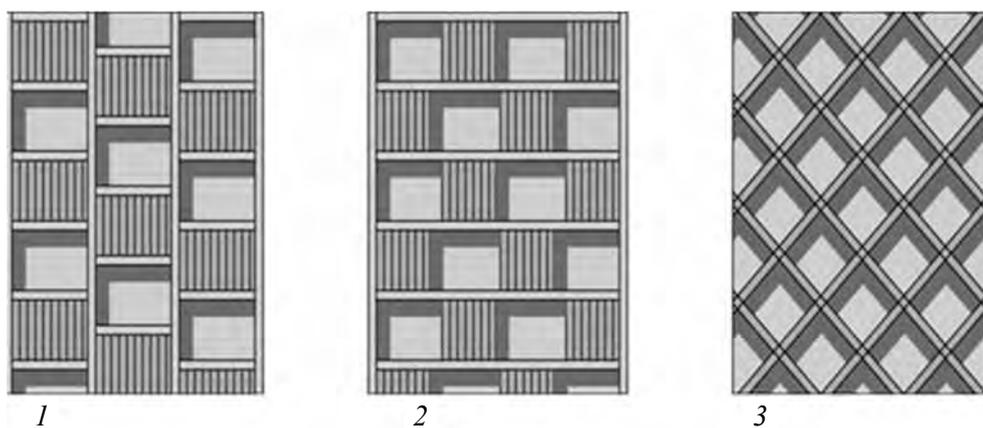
Функционально-конструктивные решения трехмерных фасадных экологических плит, создающих разный ритмический строй на фасадах зданий:
